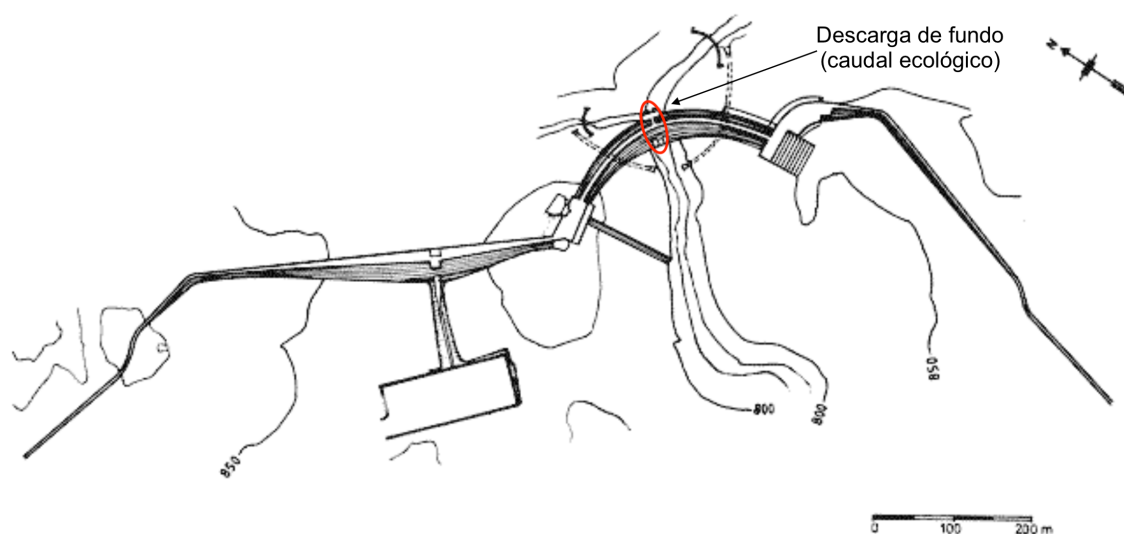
Barragem do Alto Rabagão. Planta. Adaptado de (cnpgeb.apambiente.pt).
